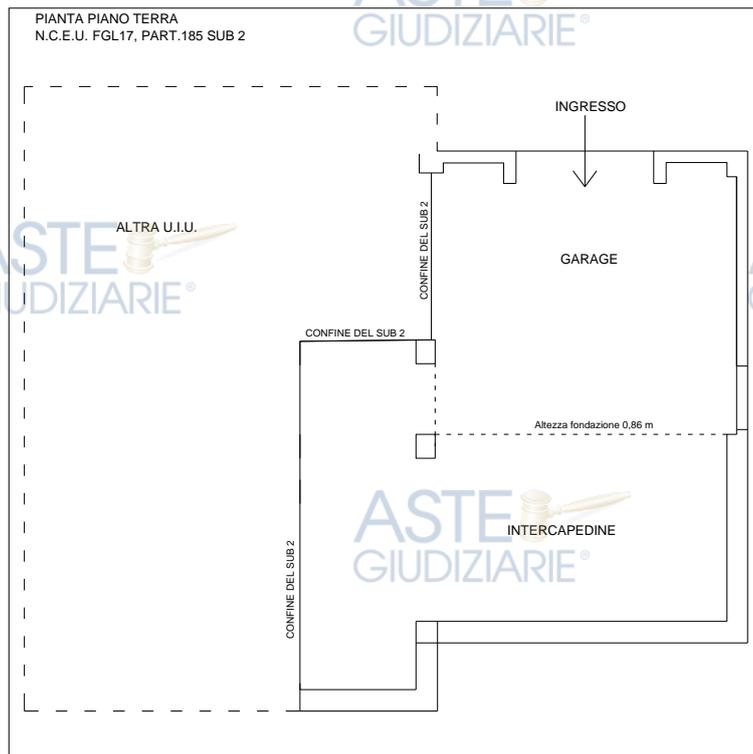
Pianta piano seminterrato rilevata in sede di sopralluogo.
